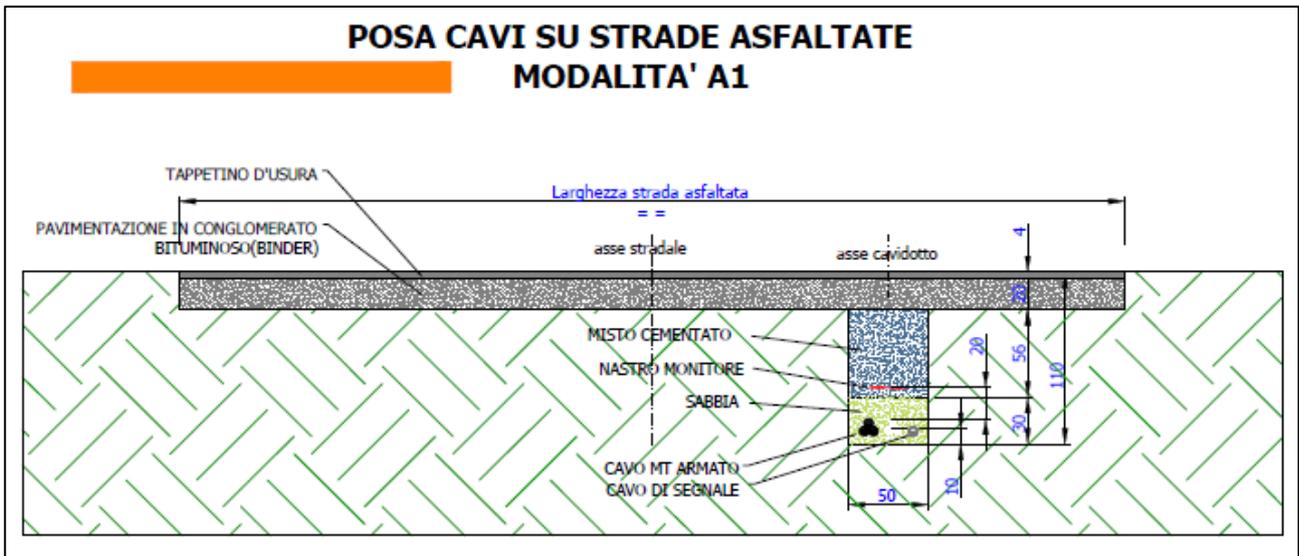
Cavidotto su viabilità asfaltata - posa terna singola
